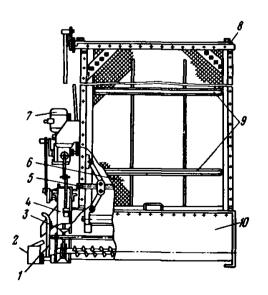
Самоочищающийся воздушный фильтр типа Кт-30: 1- трубка слива масла; 2- шламовый бачок; 3- элеватор; 4- шламовый колодец; 5- натяжное устройство; 6- фильтрующая сетка; 7- электропривод; 8- головка фильтра; 9- ограничитель наружный; 10- бак
